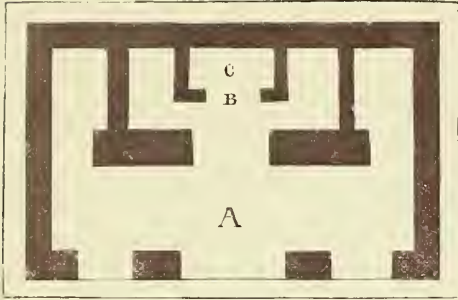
PLANTA DEL TEMPLO DE LA CRUZ, EN PALENQUE
